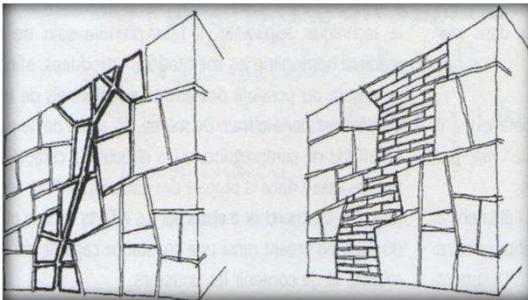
Reprise des fissures sur un mur en maçonnerie.
